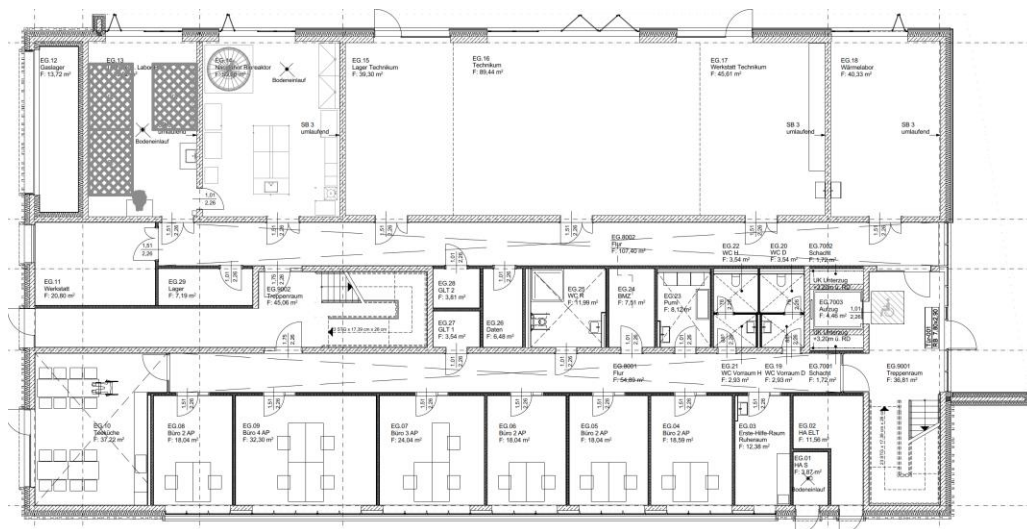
Auszug aus DZS-XXX-ARC-ARC-3-GR-EG-X-XXX-01-v-Grundriss Erdgeschoss
